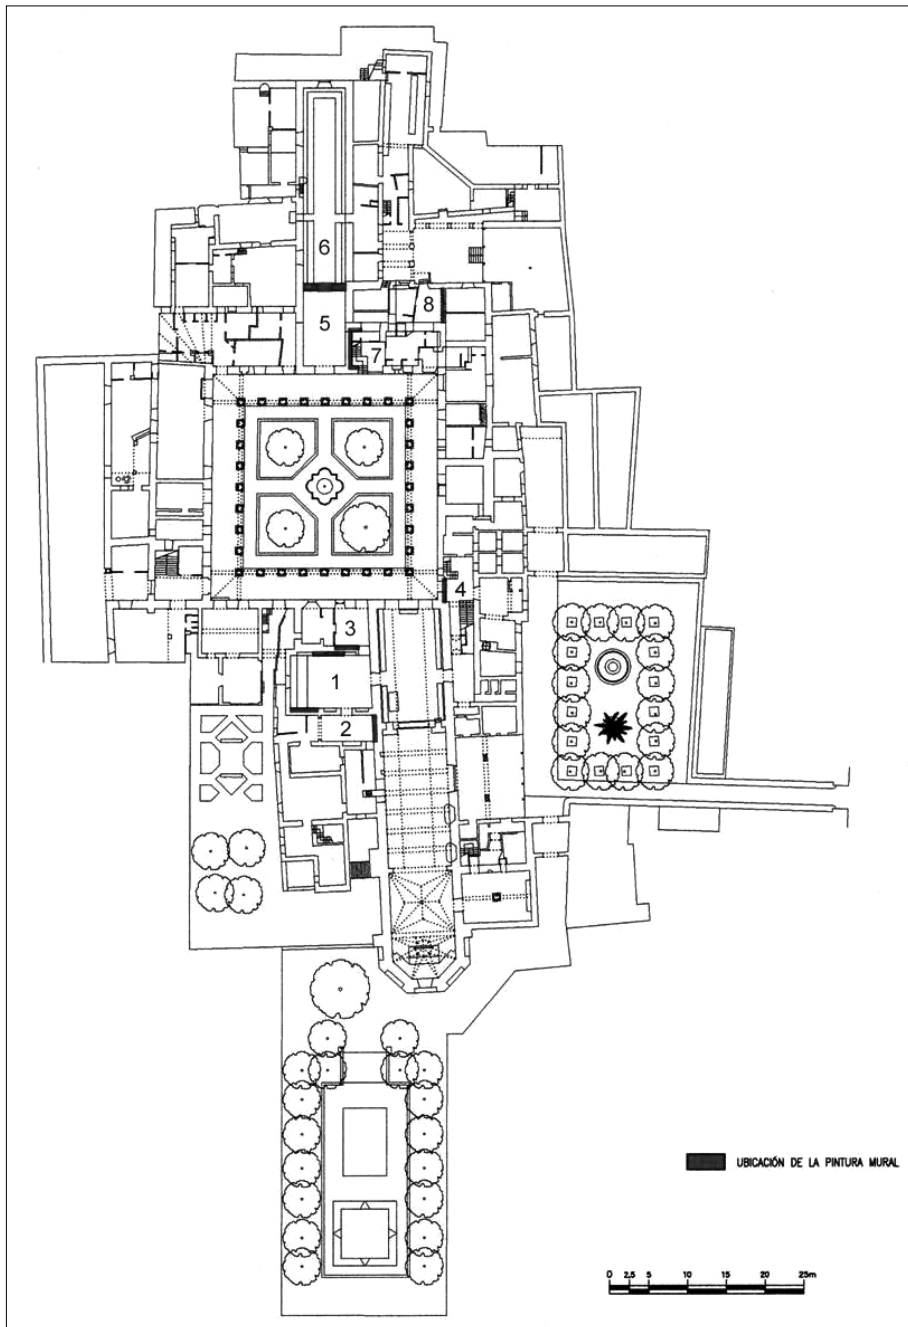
Planta baja del monasterio de Santa Clara donde se numeran las estancias que contienen decoración pictórica. Plano: Luis Núñez Arce.
